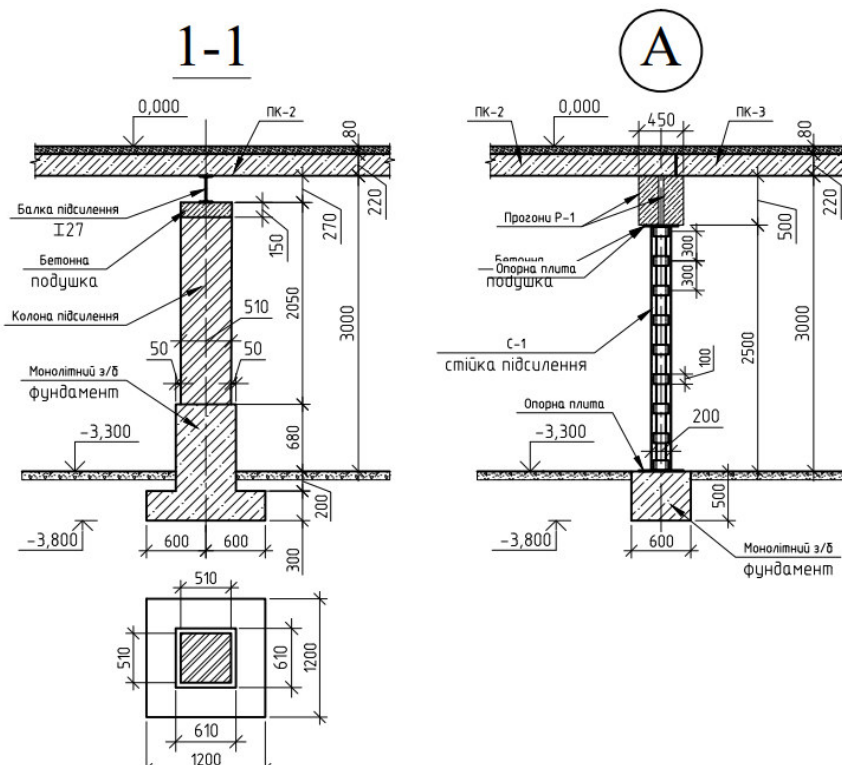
Підсилення конструкцій перекриття підвалу будівлі
